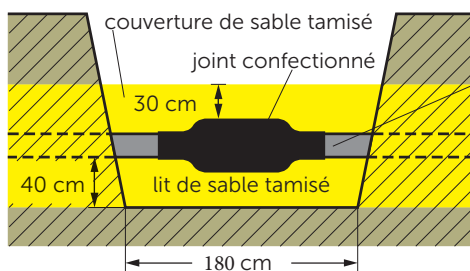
Joint confectionné dans la fouille de jointage avec protection du câble et du joint par une couverture de sable
